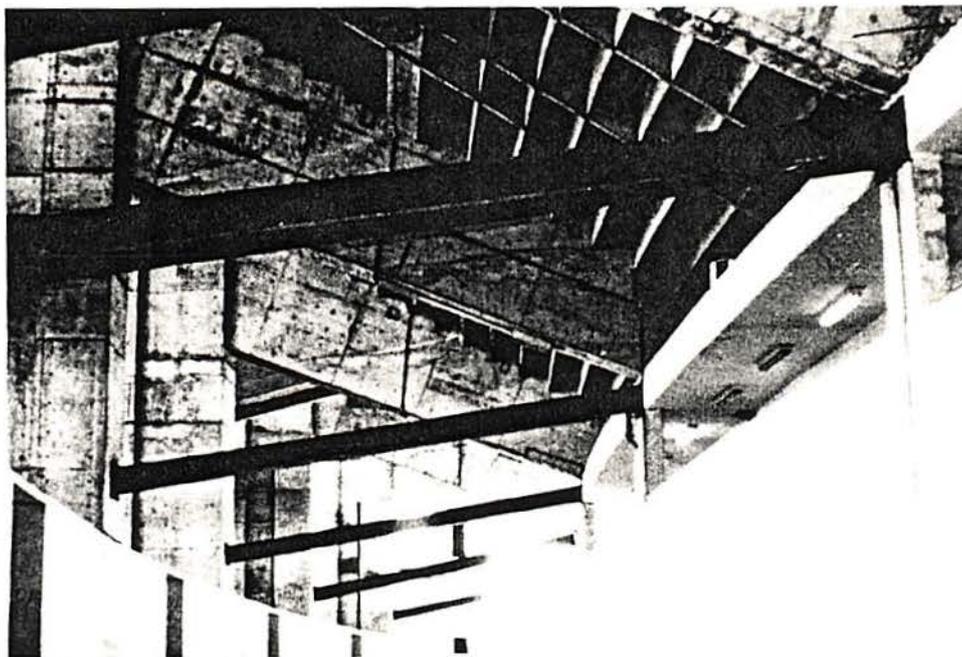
Adequação estrutural das arquibancadas de um estádio de futebol através da incorporação de vigas caixão metálicas, fixadas à estrutura de concreto -vigas e pilares- por meio de parafusos com luva expansora
